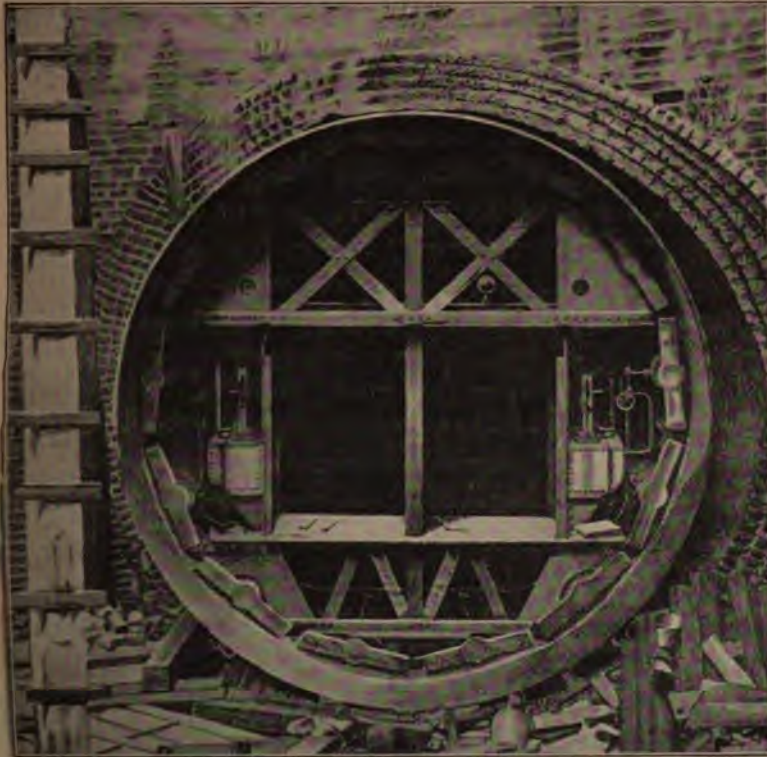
Deuxième bouclier. — Vue arrière pendant le montage.
